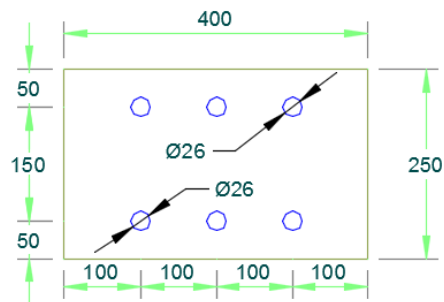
Detalle platina de apoyo $e=3/4"$, zona B. Fuente: Autor.
